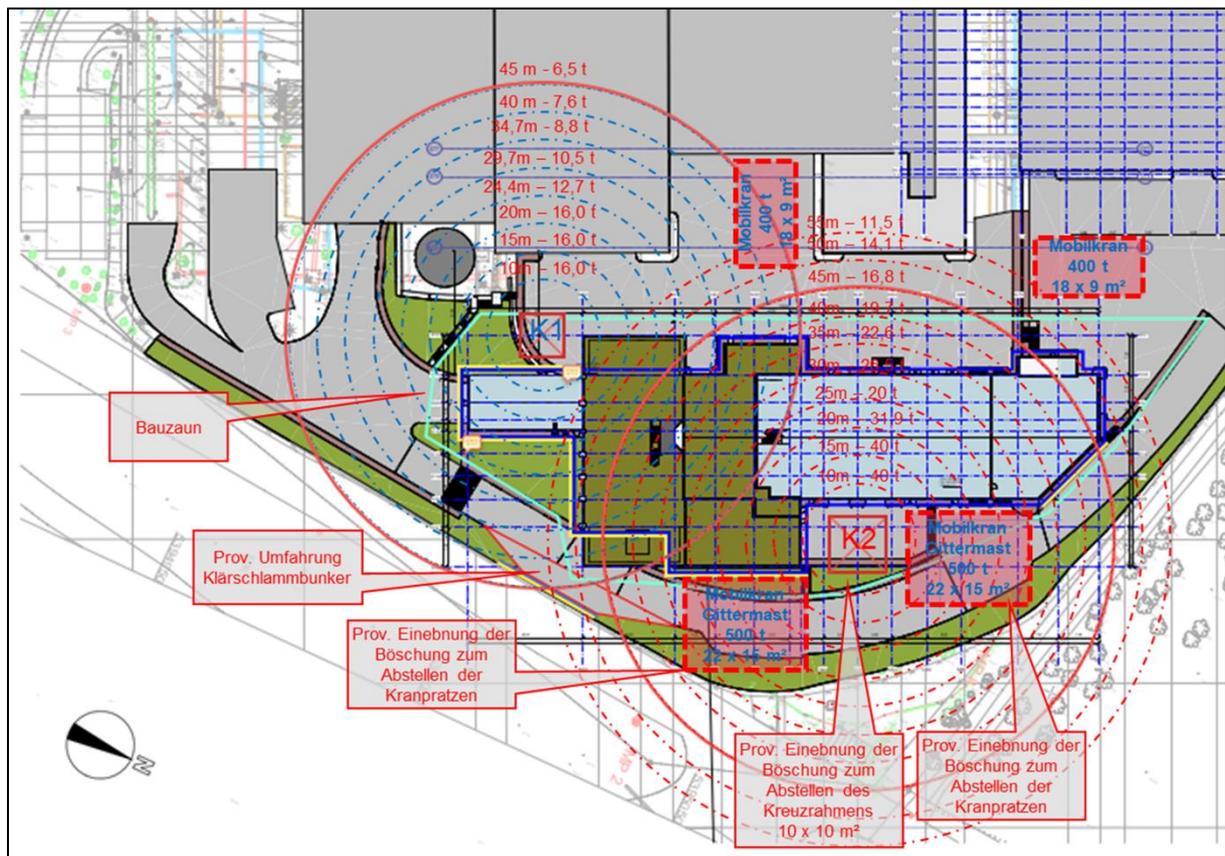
Lageplan mit den geplanten Aufstellungsorten für fest installierte und Mobilkrane
